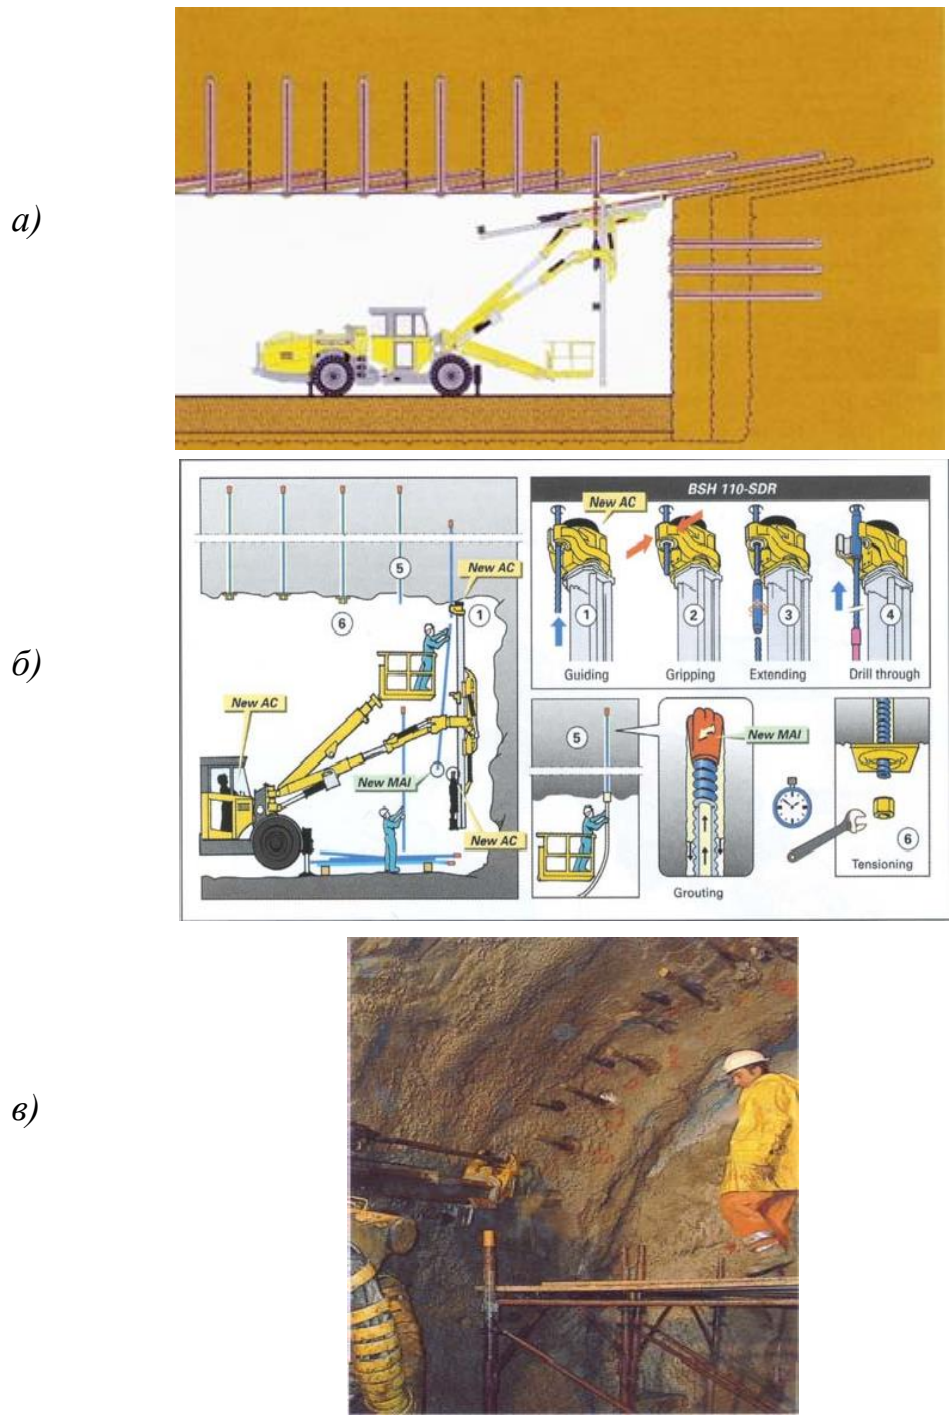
Система попереднього анкерного кріплення склепіння та вибою виробітку: а) буріння шпурів; б) монтаж анкерів у склепінні; в) монтаж анкерів у вибої
